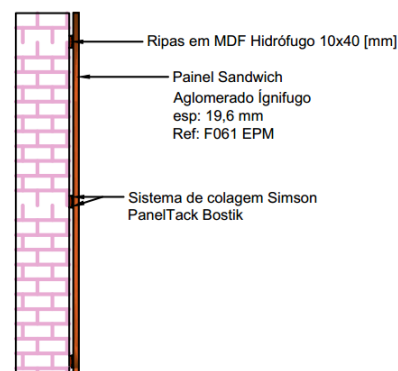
Vista em planta da aplicação do Painel sandwich revestido a HPL [Fonte: NiNi Andrade]
